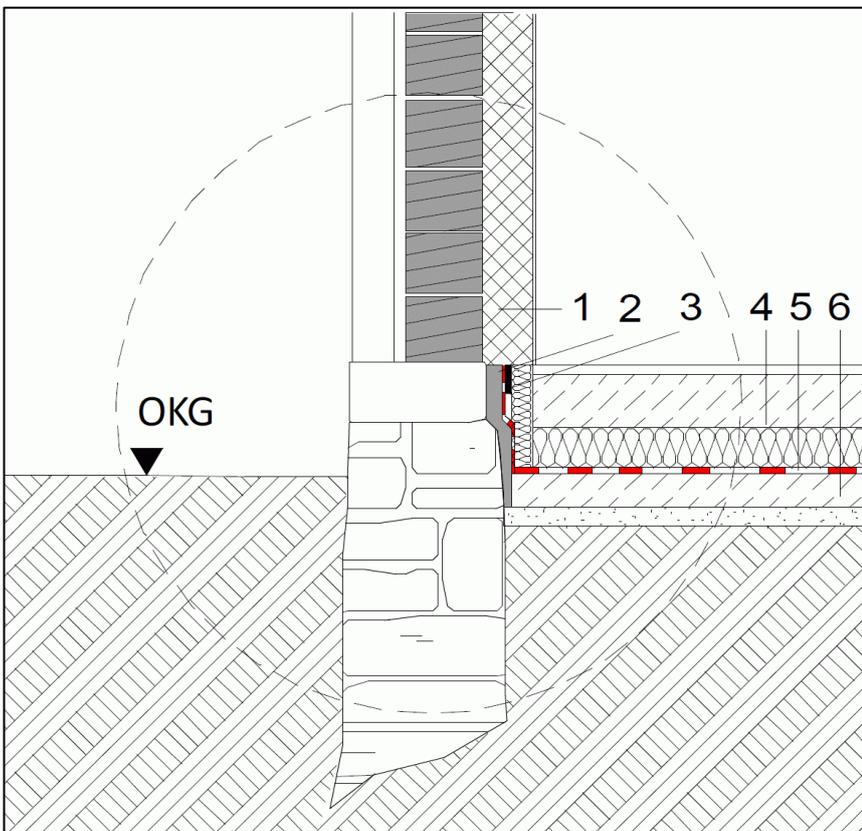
Beispiel Umgebäudehaus: Außenwandanschluss, Sanierungsvariante 2
